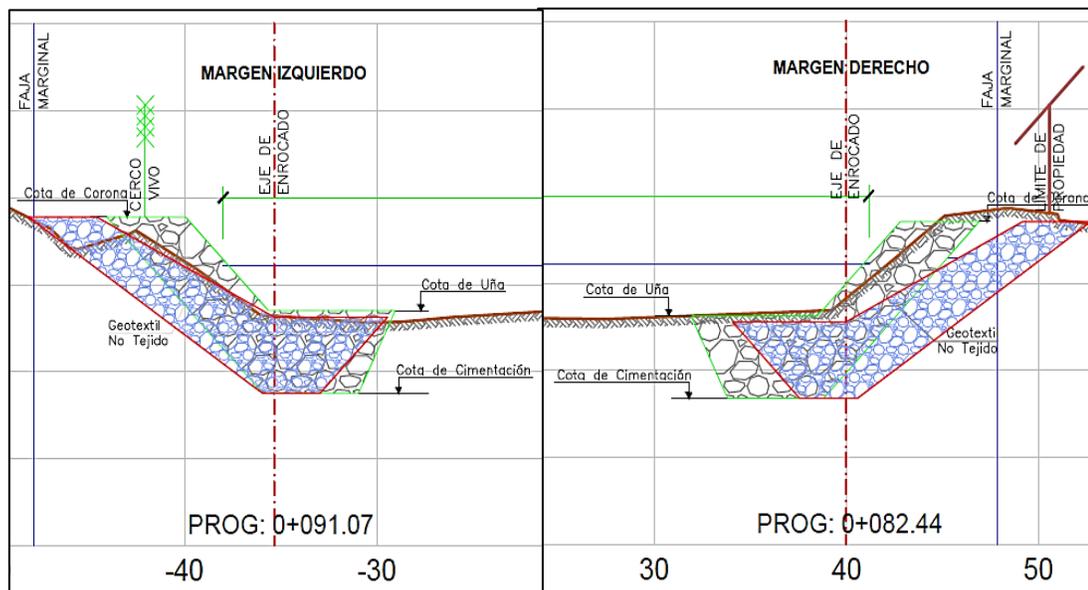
Sección transversal, EDI y propuesta, aguas abajo.
